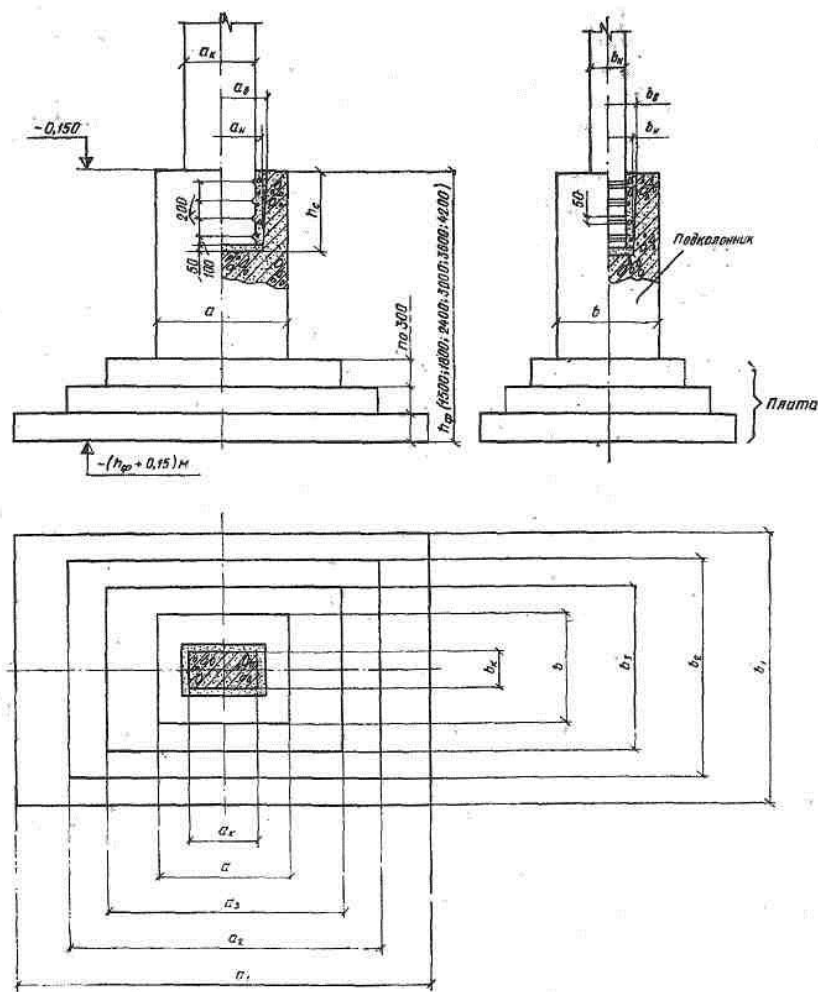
Збірний залізобетонний фундамент [6].
